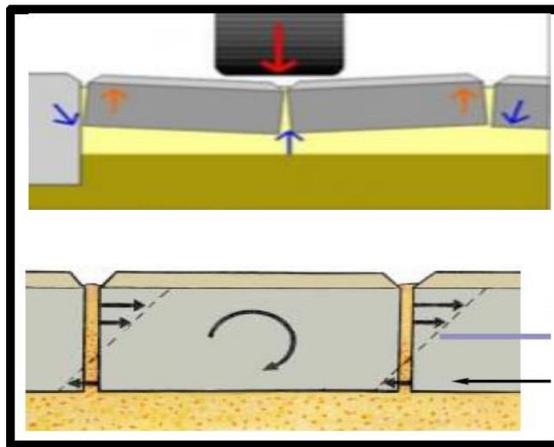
Esquema de cargas dinámicas que actúan en un pavimento adoquinado
